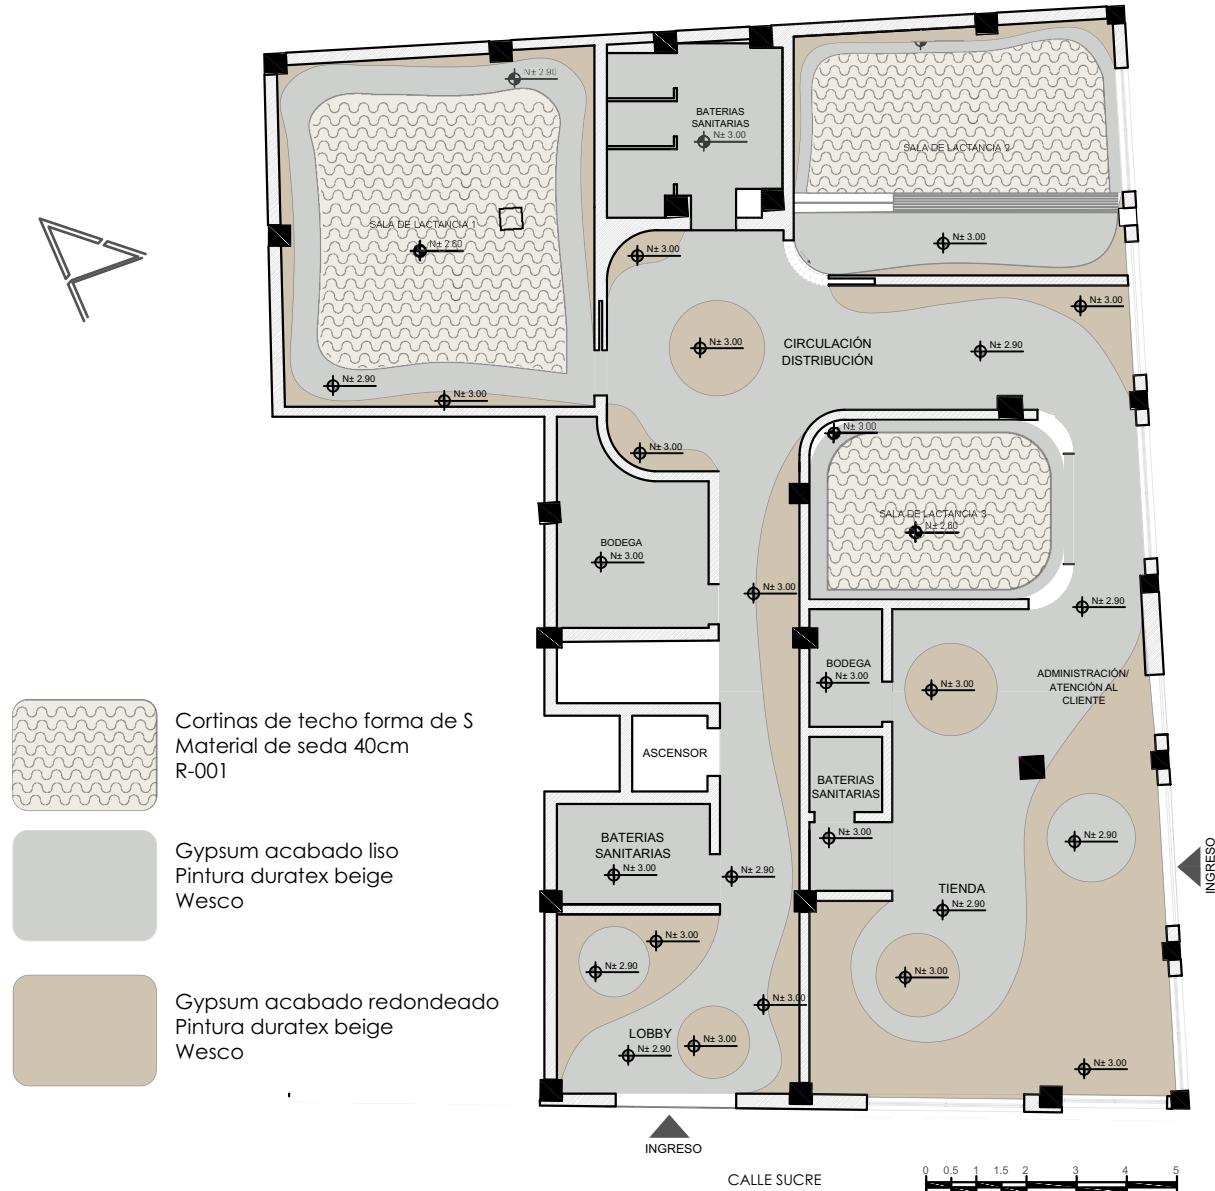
Fuente MIDUVI Edición Liliana Tréboles. PLANTA DE TECHOS
